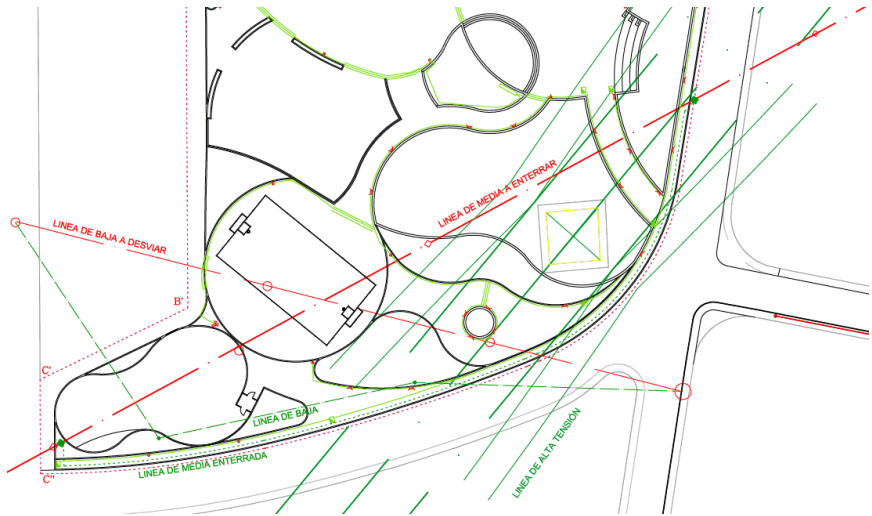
Planta de instalaciones eléctricas y alumbrado
